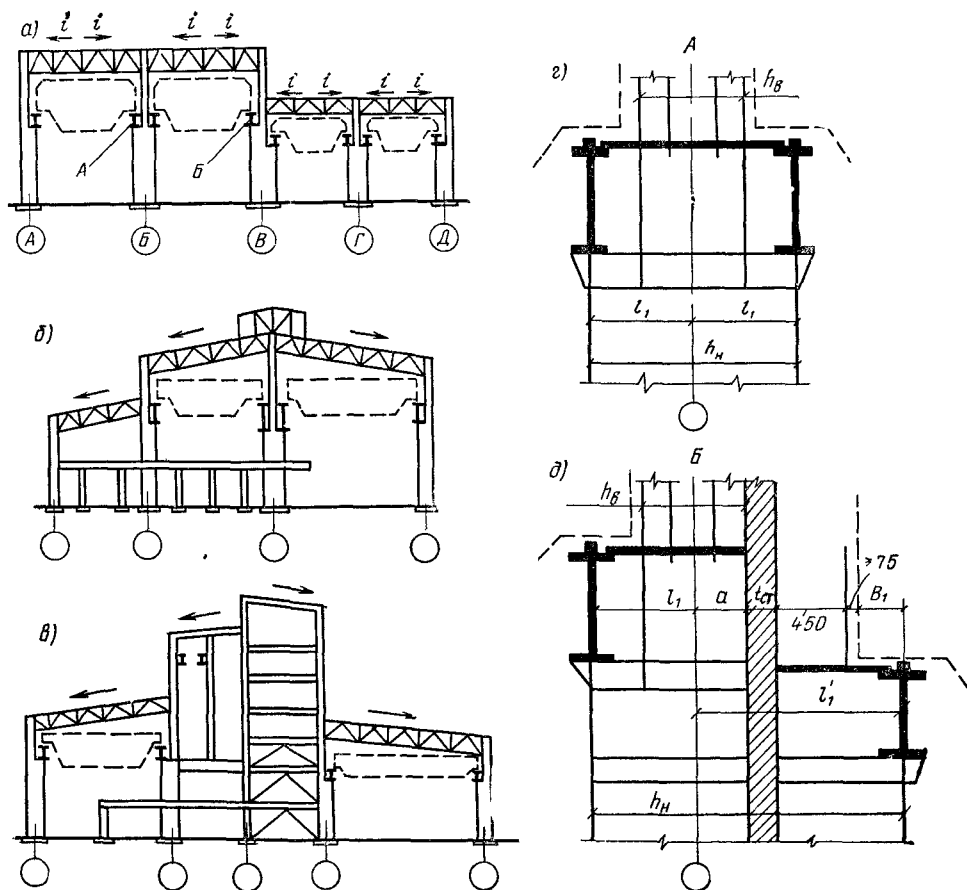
Примеры схем поперечных рам многопролетных зданий
